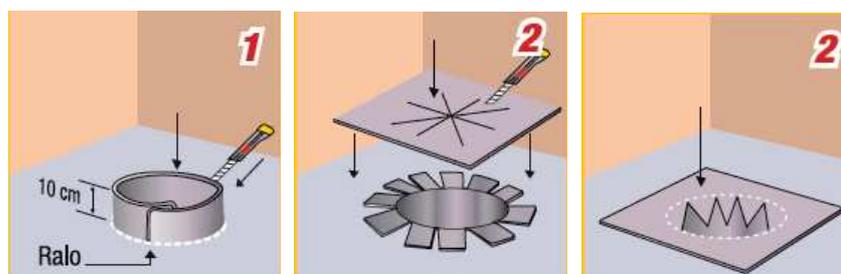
Detalhe da execução do reforço da impermeabilização dos ralos
